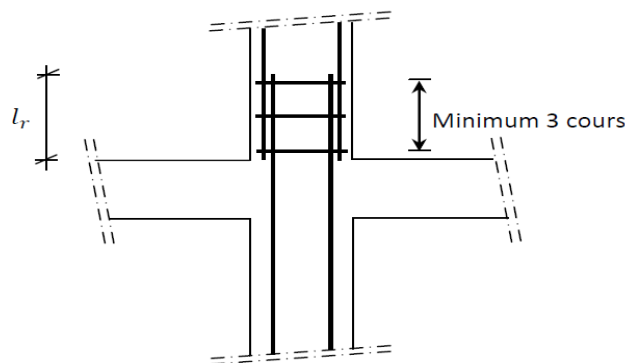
les armatures transversales dans la zone de recouvrement
